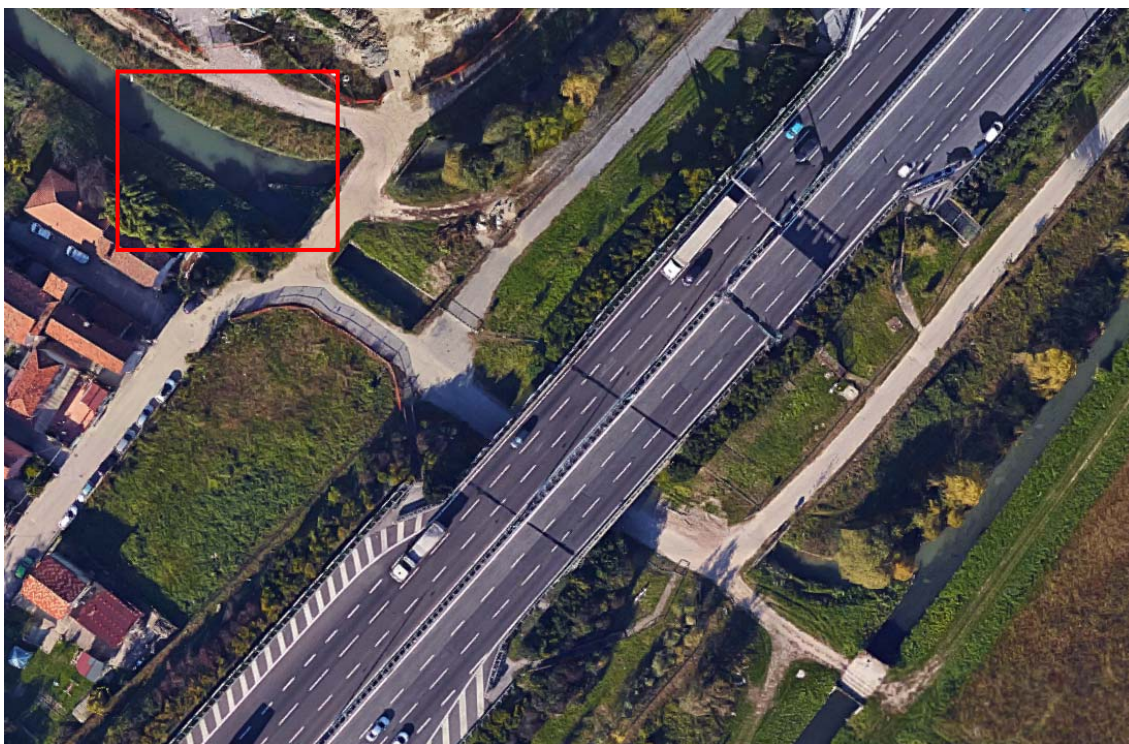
Vista planimetrica della zona oggetto di intervento
